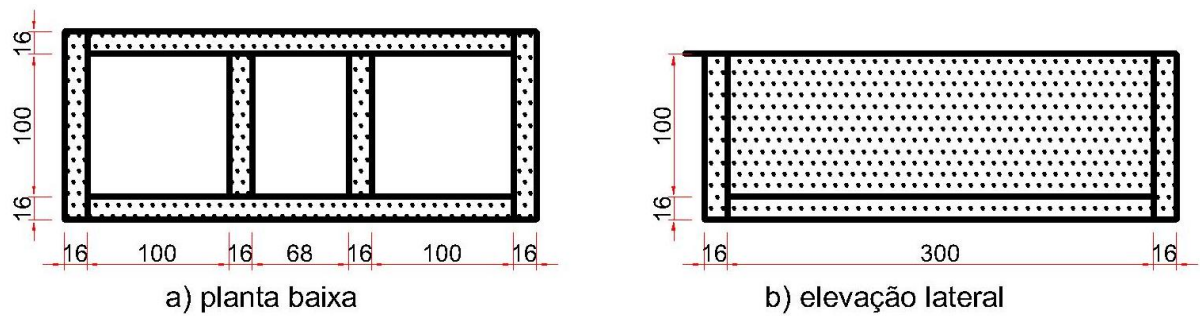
Planta de fôrmas para a primeira etapa de concretagem das peças compostas
